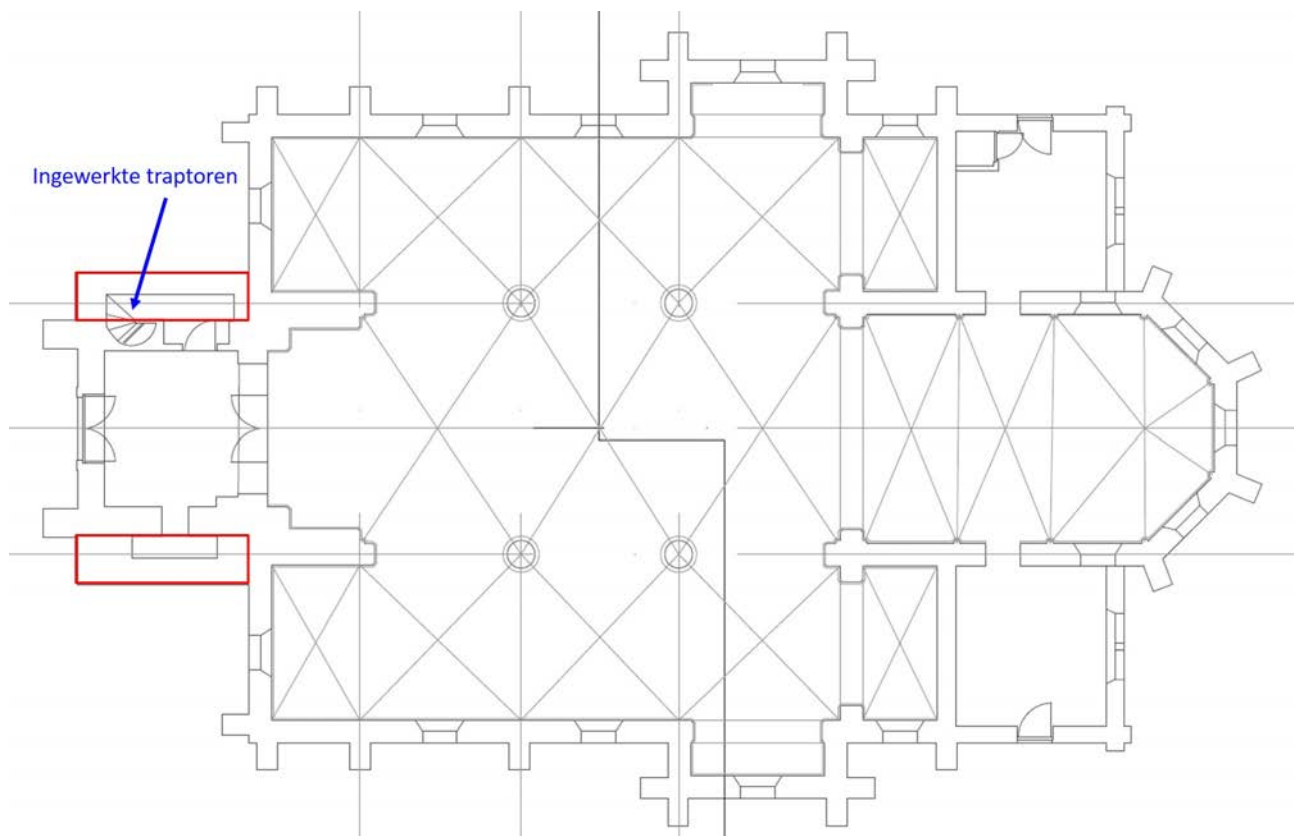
Grondplan van de kerk met aanduiding van traptoren en noord- en zuidelijke aanbouw
